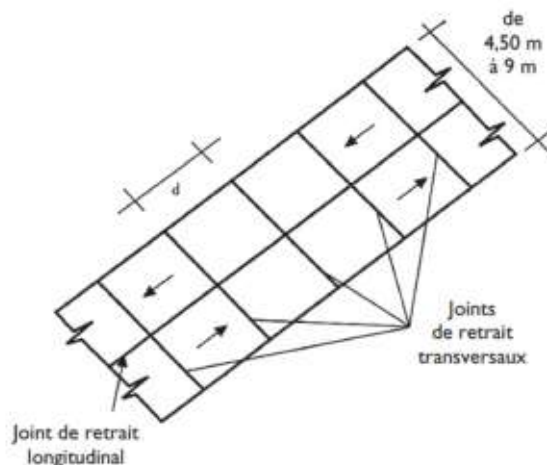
Disposition des joints de retrait / flexion transversaux et longitudinaux (source CimBéton).
